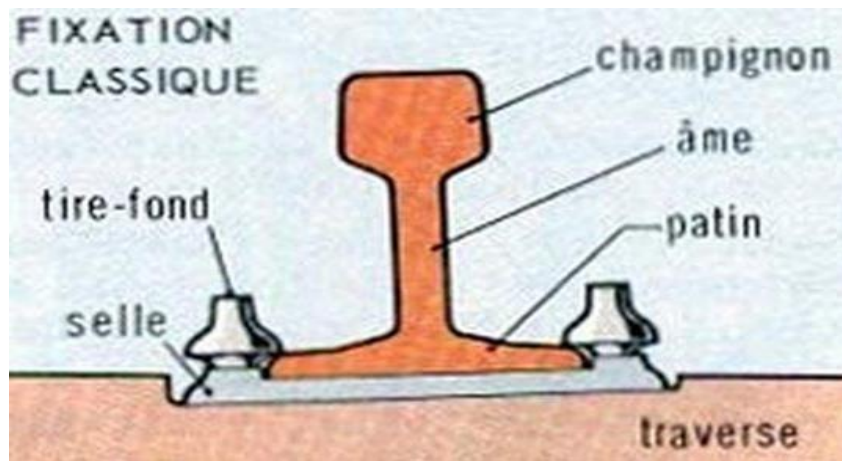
Fixation du rail Vignole sur traverse en bois.
